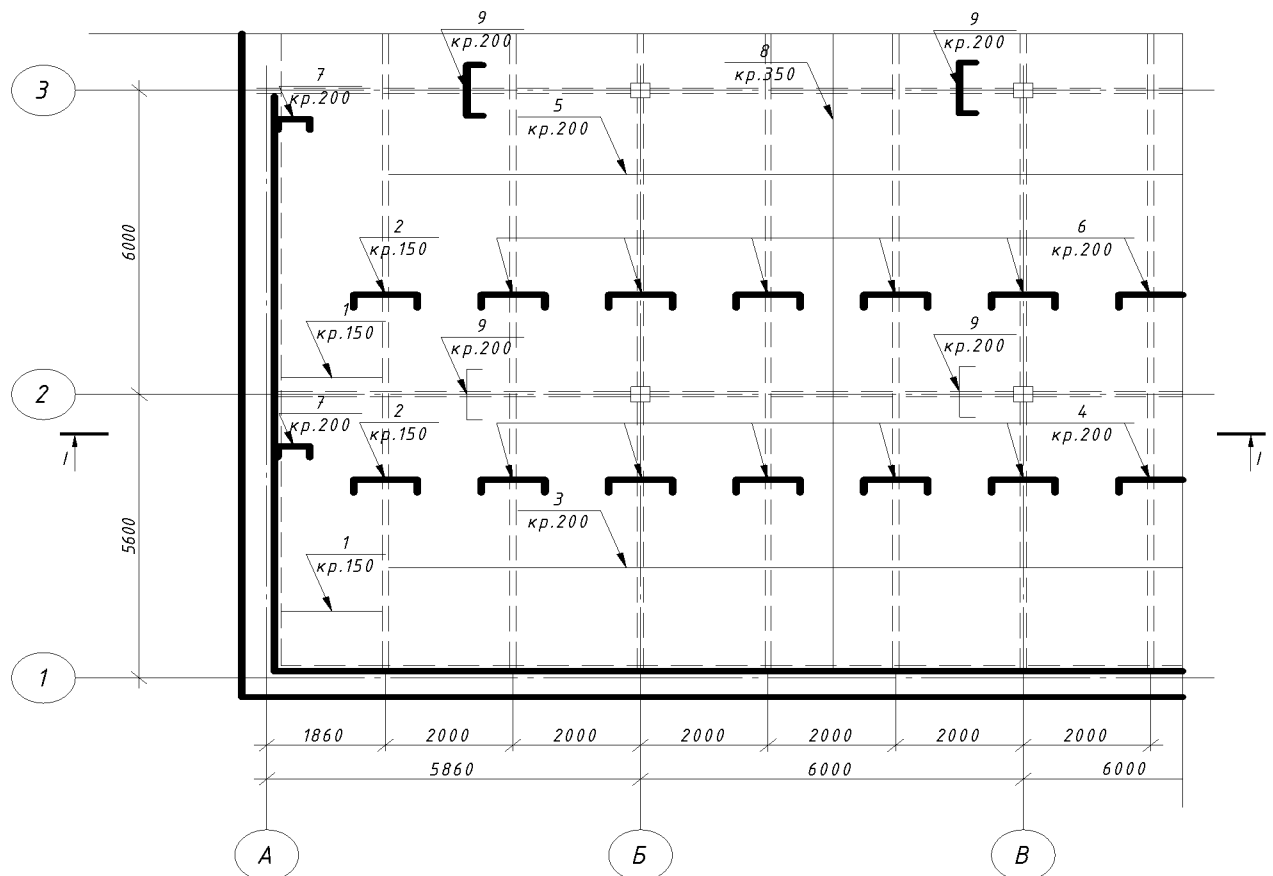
Армування плити в'язаними сітками (окремими стержнями) без відгинів
